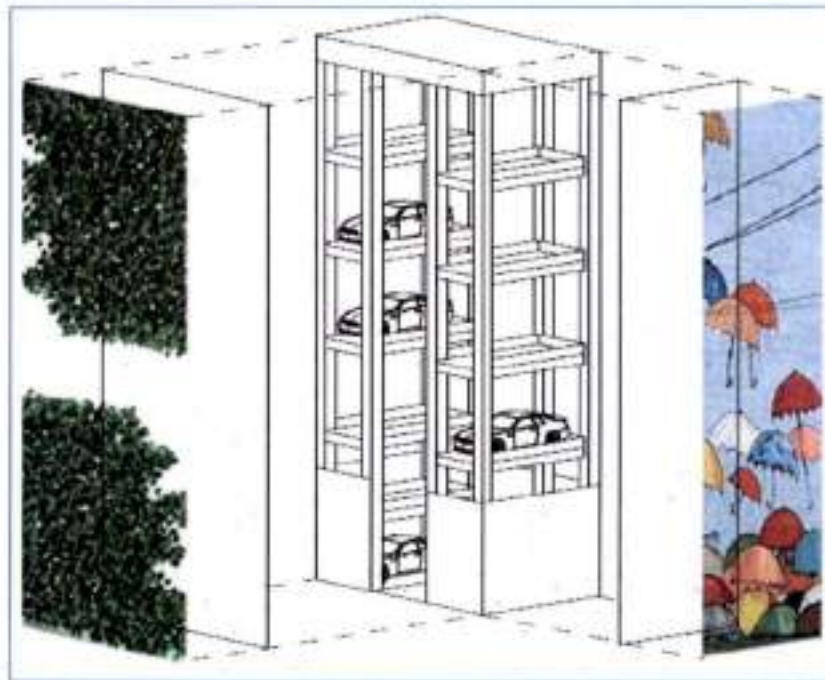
Exemplu de bună practică – propunere de animare a fațadelor structurilor de tip smart parking.
